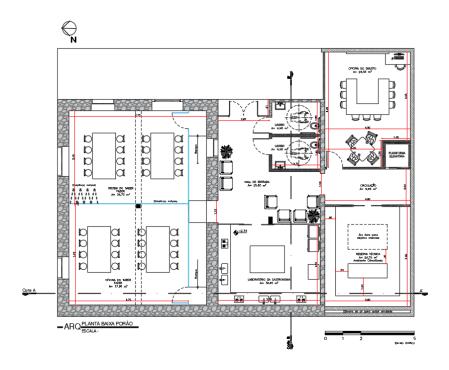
Planta baixa do porão. Fonte: Arq. Urb. Me. Adilson Giglioli.
